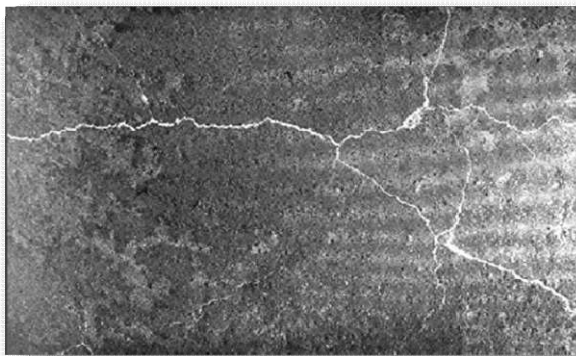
Fissuration d'une dalle (Venuat 1992).
